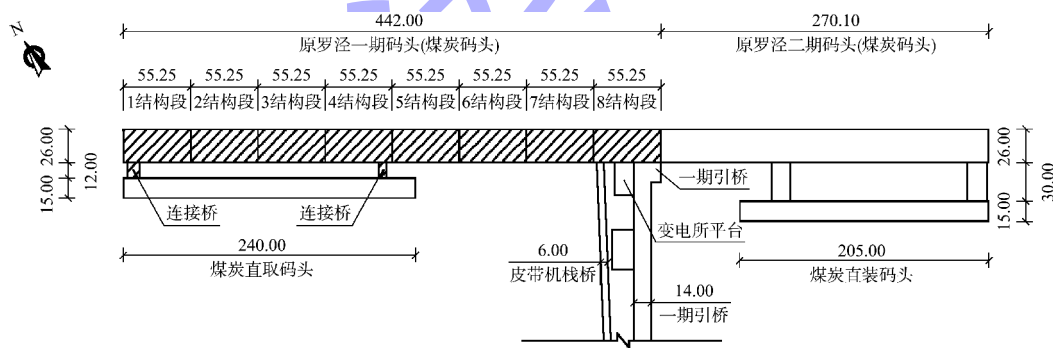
原煤炭一期卸船码头平面布置 (单位: m)
